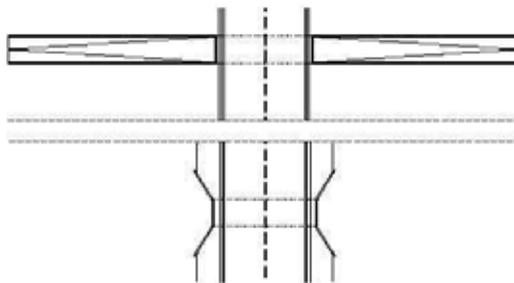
Figura PASO INFERIOR PARA PEATONES. DISPOSICIONES RECOMENDADAS EN PLANTA.
